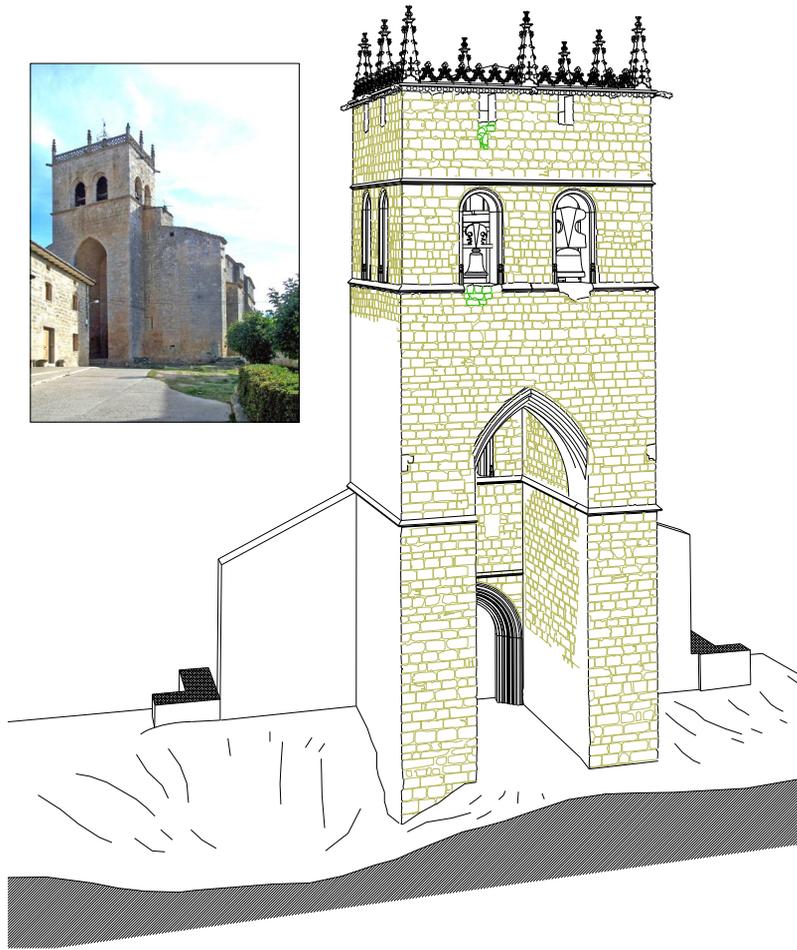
En la imagen se muestra la reconstrucción del estado original de la torre de Gumiel de Izán, con su pórtico abierto al exterior, y la fotografía del pórtico de Santa Eugenia en Villegas.
